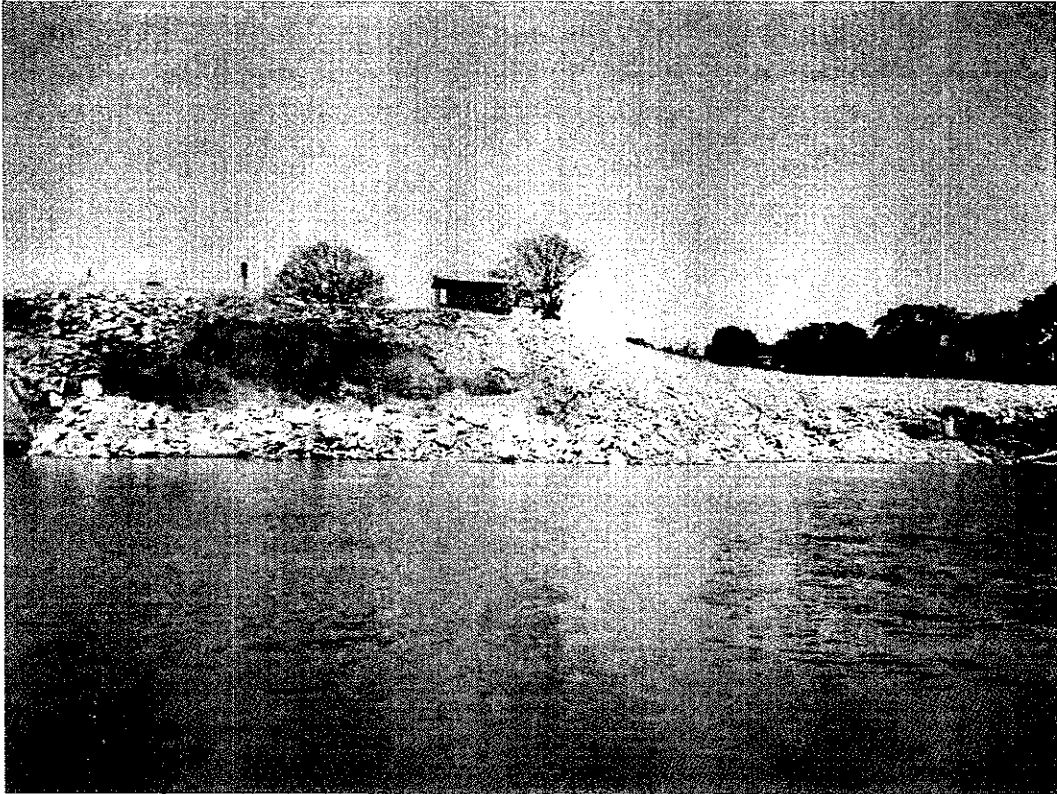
Enrocamento armazenado – 23/08/2012.
